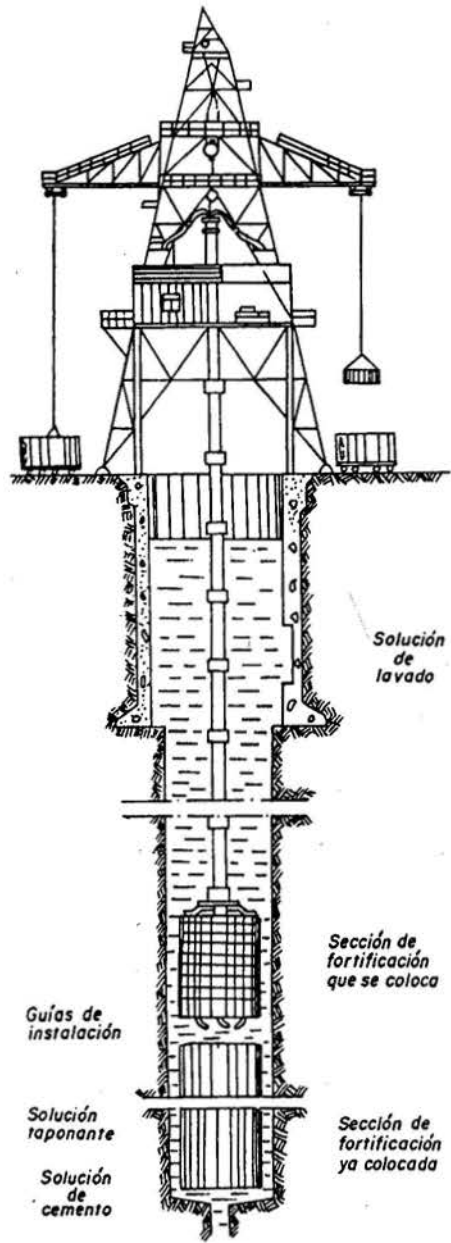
Fortificación de pozos con el empleo de la fortificación de sección.
